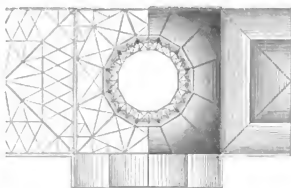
Grundris der Dach- und Kuppel-Konstruktionen.
